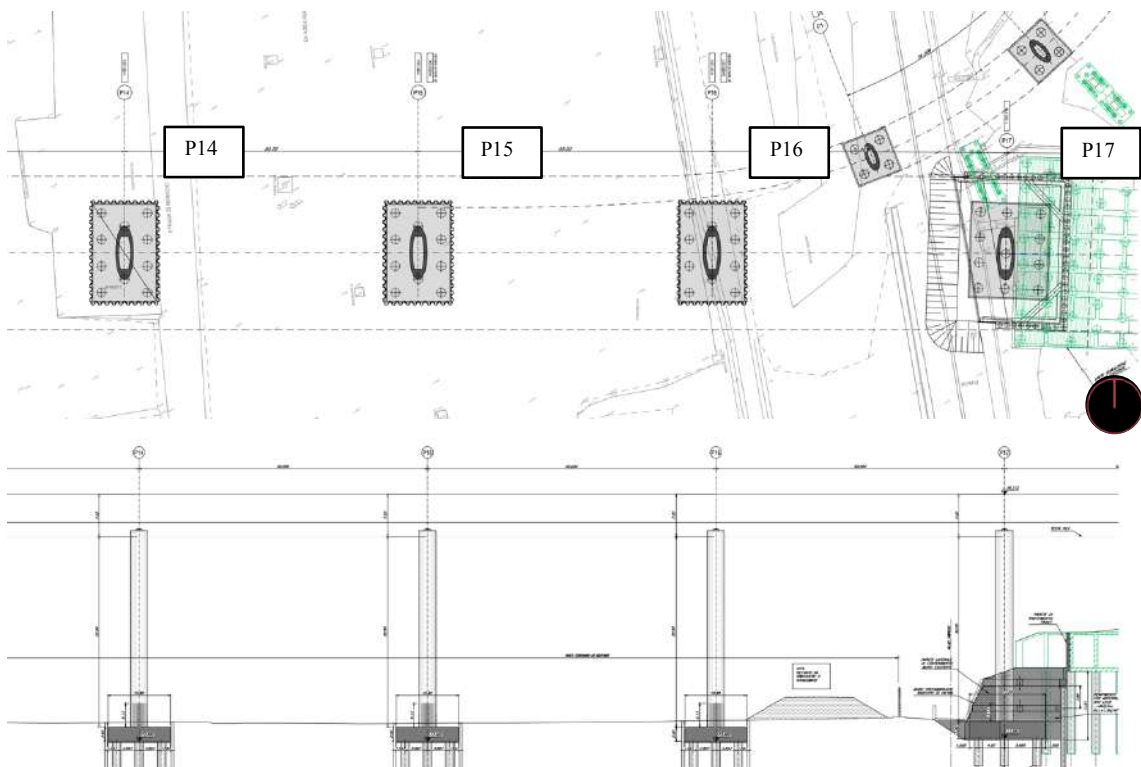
Planta e elevação lateral dos pilares elípticos P14, P15, P16, P17 e respectivas fundações.
